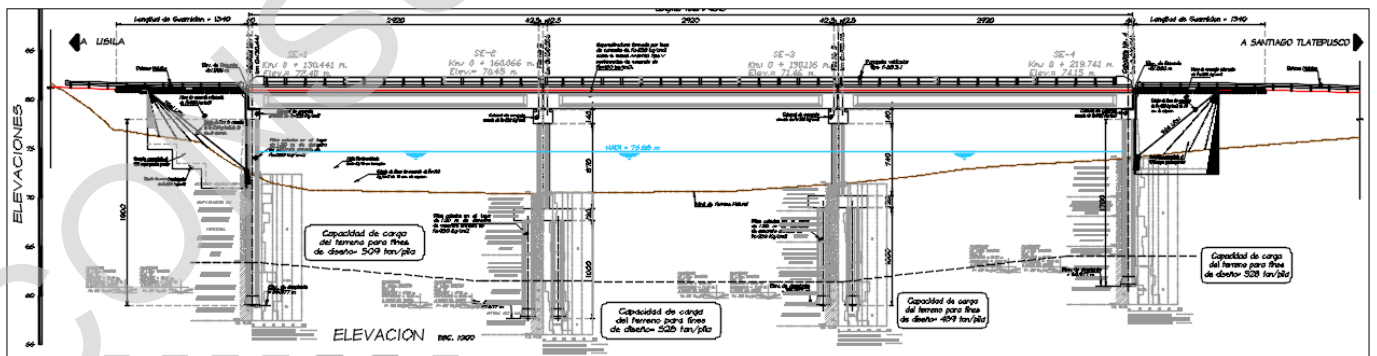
Elevación general del proyecto de construcción del puente "Tlatepusco".
